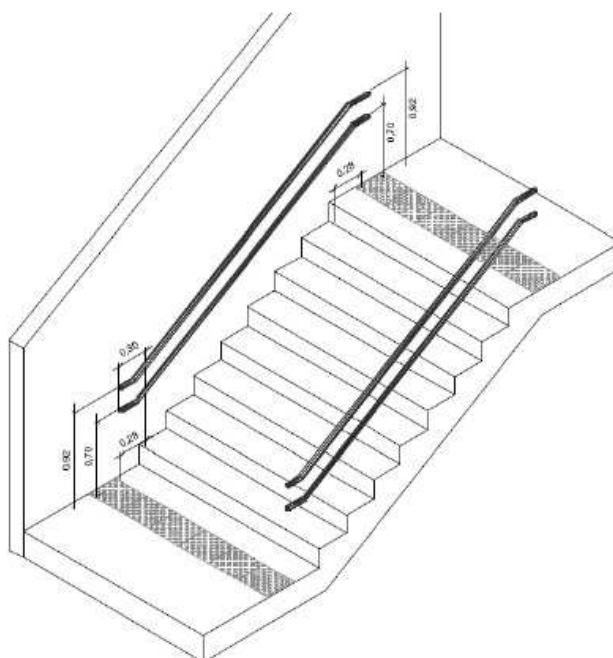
Esquema da aplicação de piso tátil de alerta, em escadas
